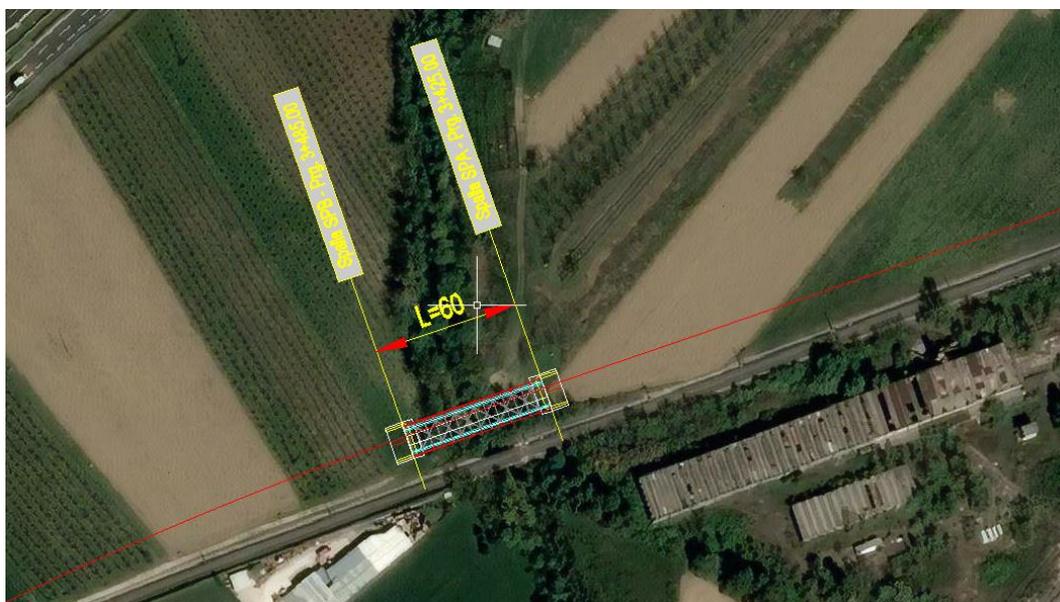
VI02 – Posizionamento su ortofoto rispetto alla linea esistente
